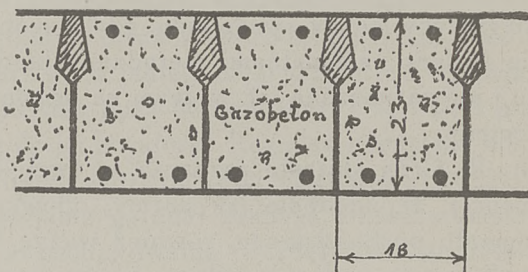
Strop żelbetowy (żebrowy) wypełniony gazobetonem.
